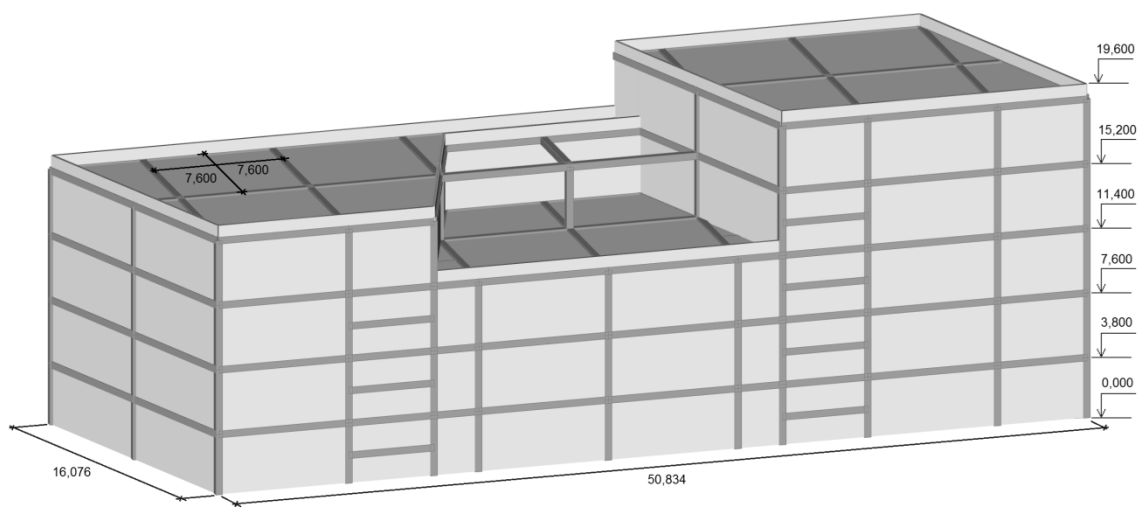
Schéma značení sloupů (rozteč v mm)
